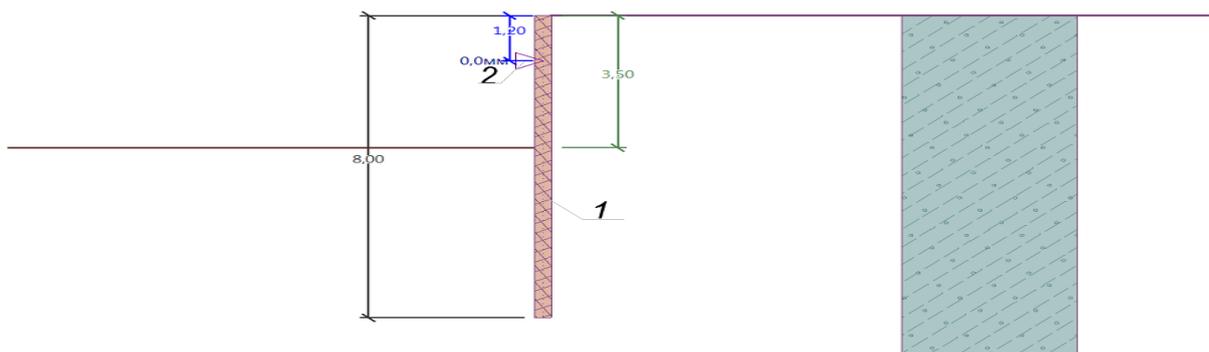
Расчетная схема конструкции шпунтовой подпорной стенки с опорной трубой
